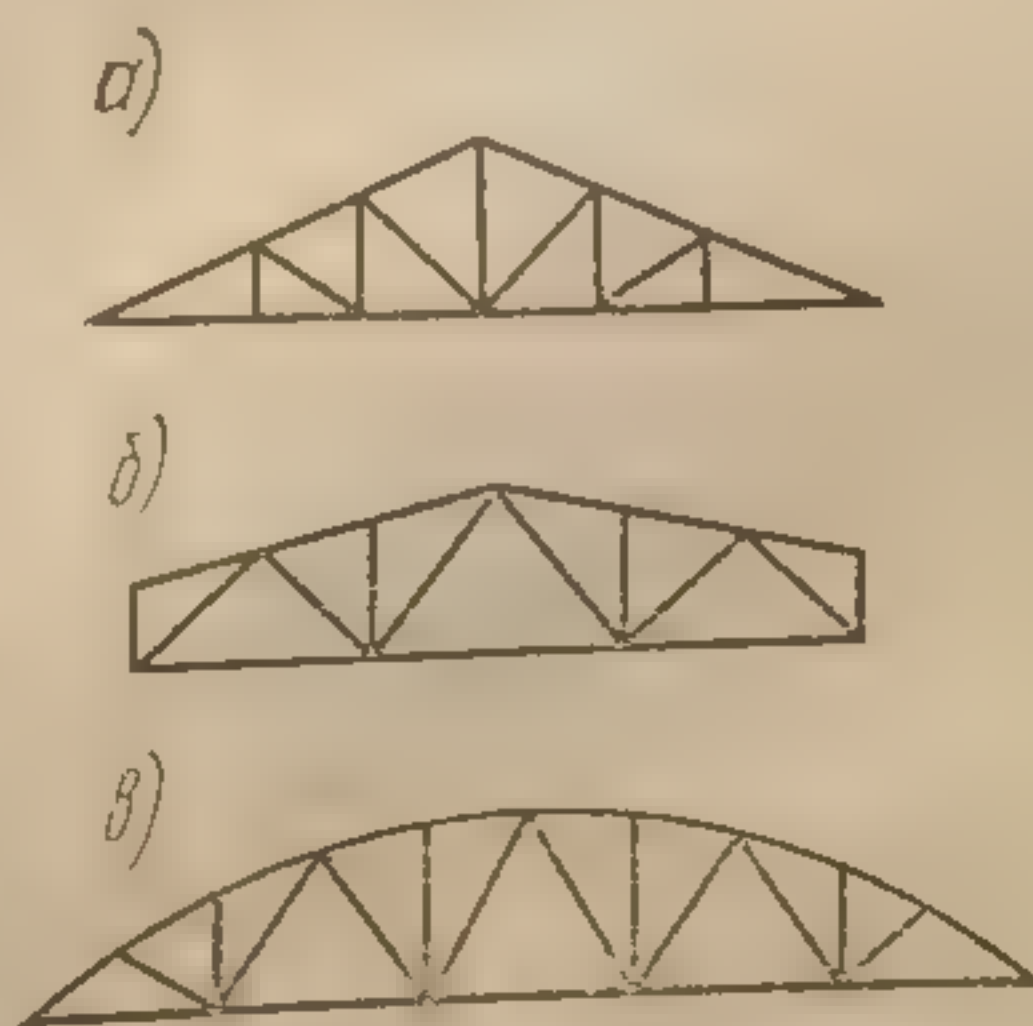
Стропильные фермы: а — треугольная; б — полигональная; в — сегментная
